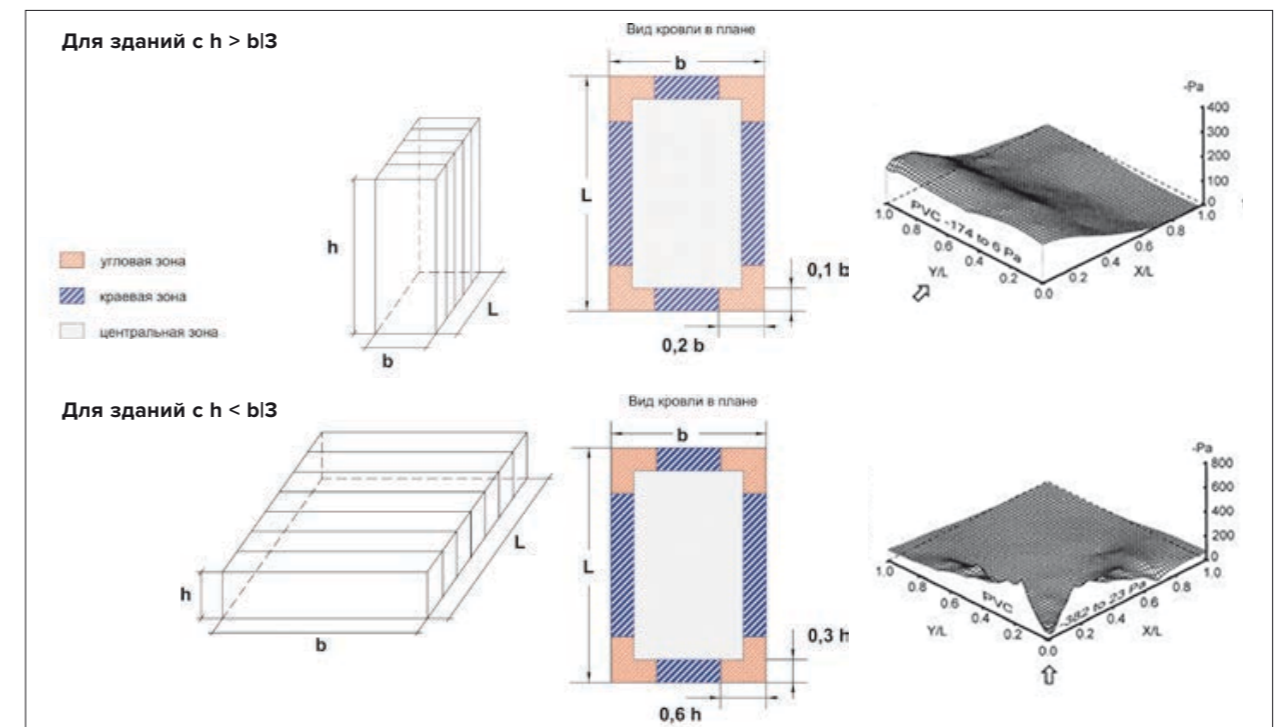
Деление кровли на зоны ветровой нагрузки.
